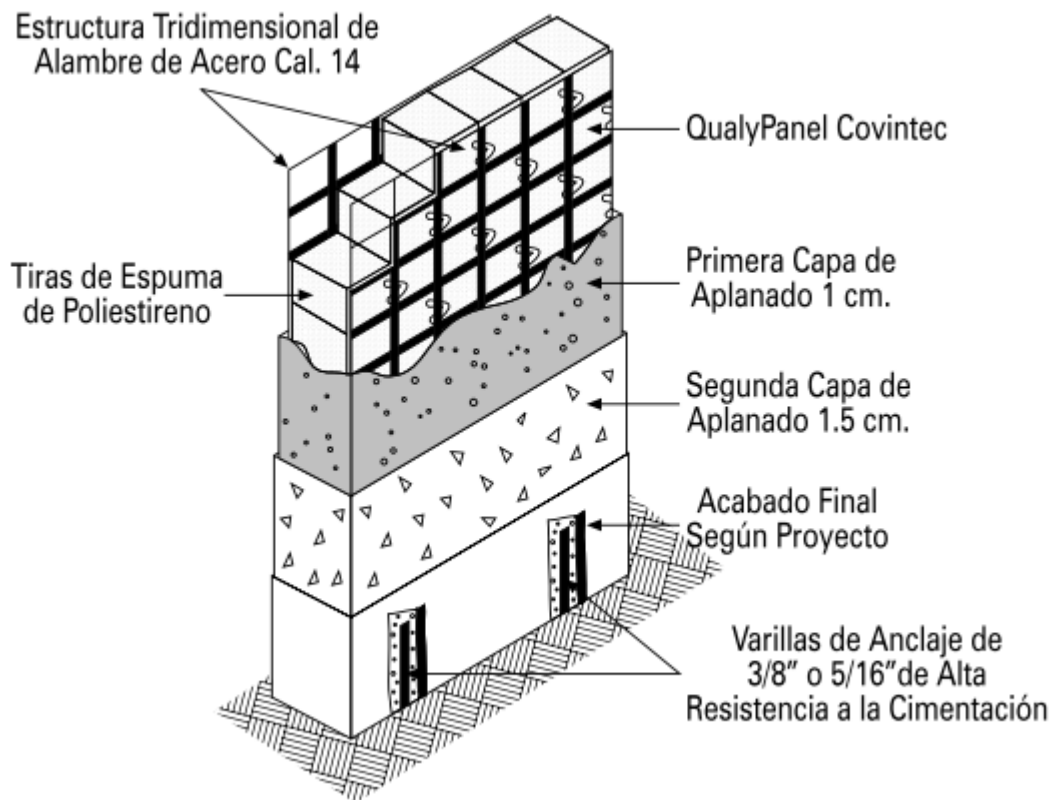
Muros sistema Covintec (Corte esquemático).
